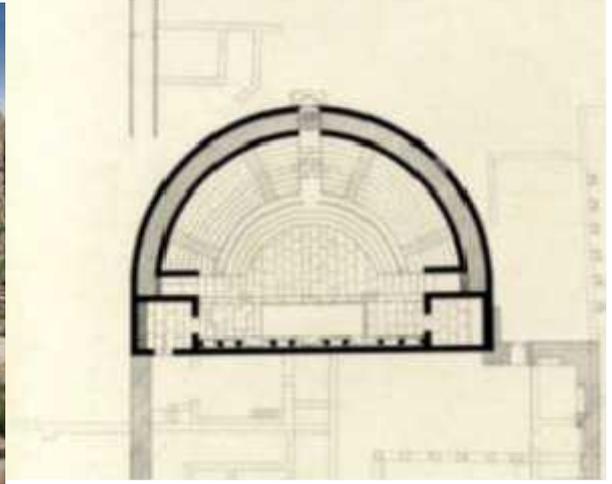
Vue de la scène, Source :auteur, Avril 2016. Figure29: Plan du théâtre, source : bounasra 1978.
